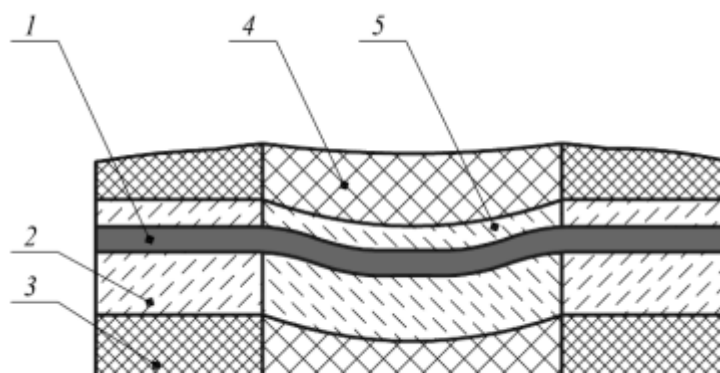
Схема осадки подземного нефтепровода: 1 – нефтепровод; 2 – оттаявший непросадочный грунт; 3 – мерзлый непросадочный грунт; 4 – мерзлый просадочный грунт; 5 – оттаявший просадочный грунт
